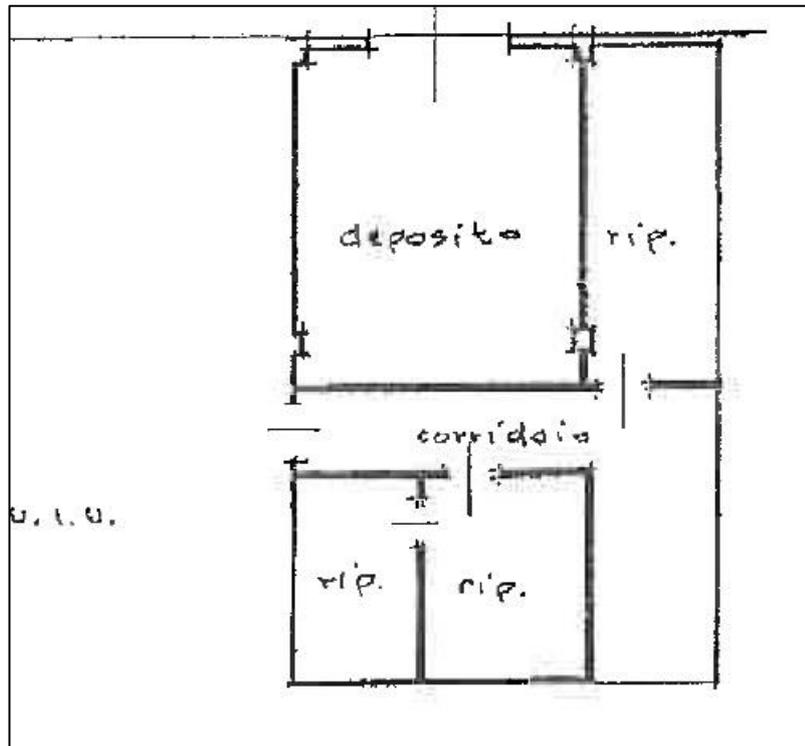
planimetria del piano S1 (sub 47) adibito a magazzino
